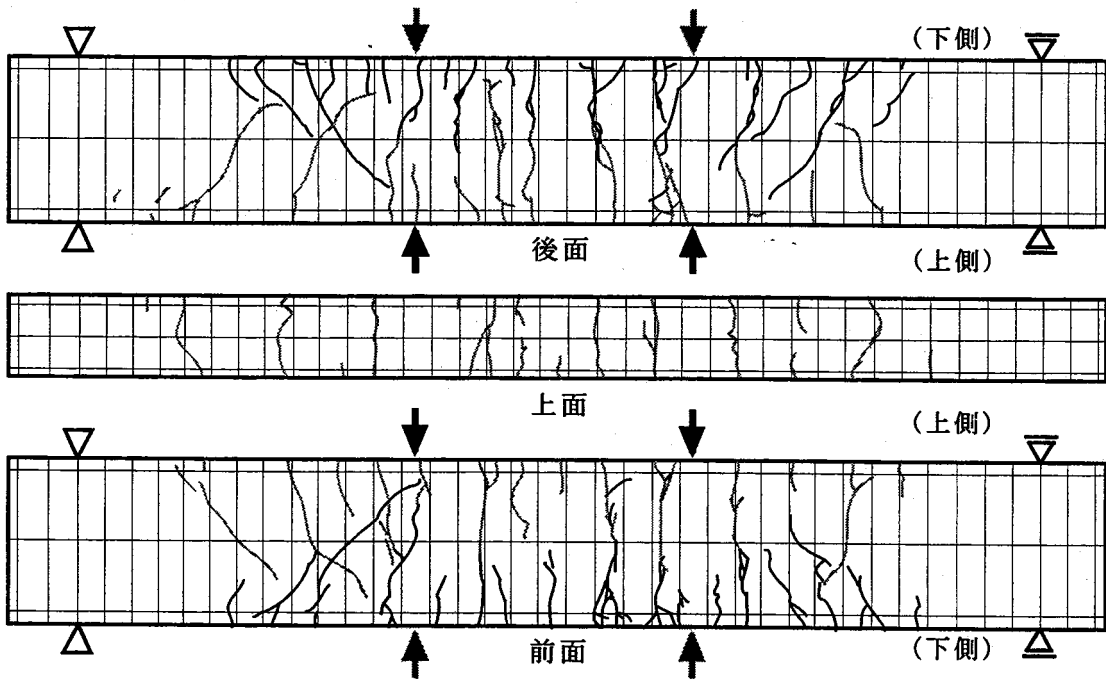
e) ひび割れ性状 [BS-3 ; R = 1/100rad.]
